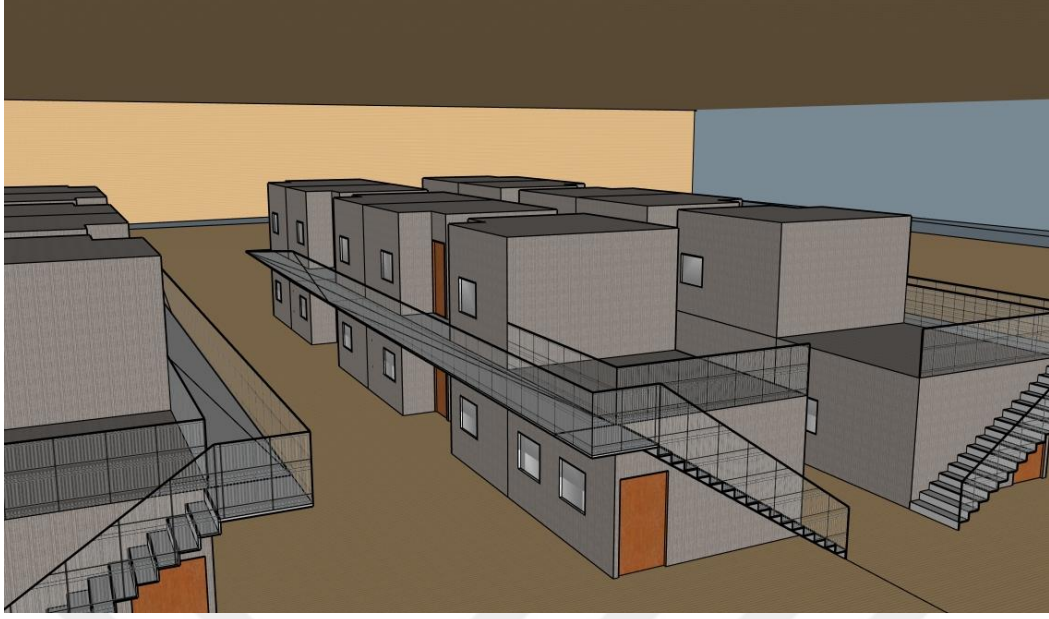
Yerleşim planı (1) (Çizen: Bitazadeh)
